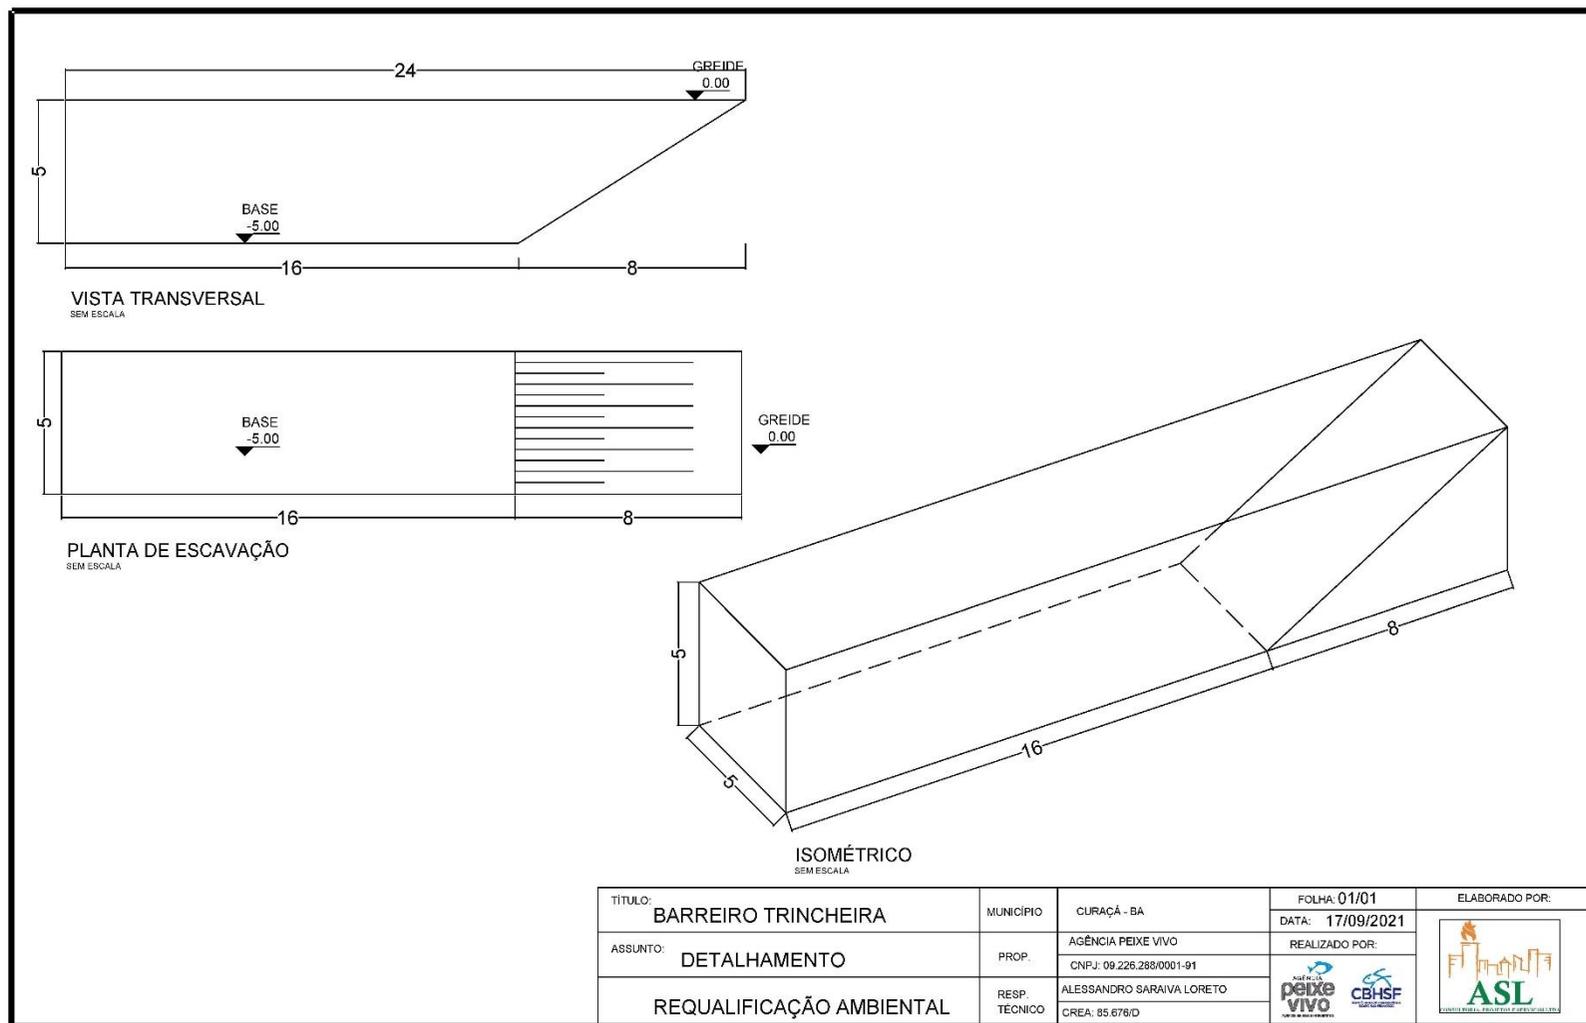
Desenho esquemático do tipo de barreira trincheira que será implantado em Curaçá.
